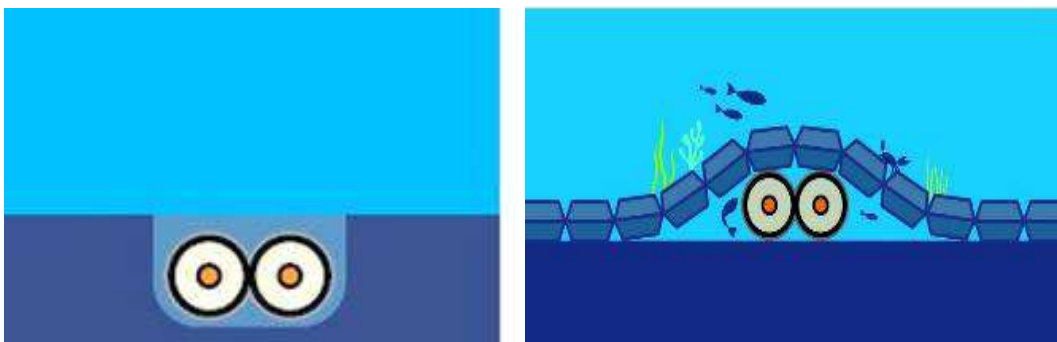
Coupe schématique d'un ensouillage (à gauche) et d'une protection externe (à droite) d'une paire de câble (RTE, 2021)
